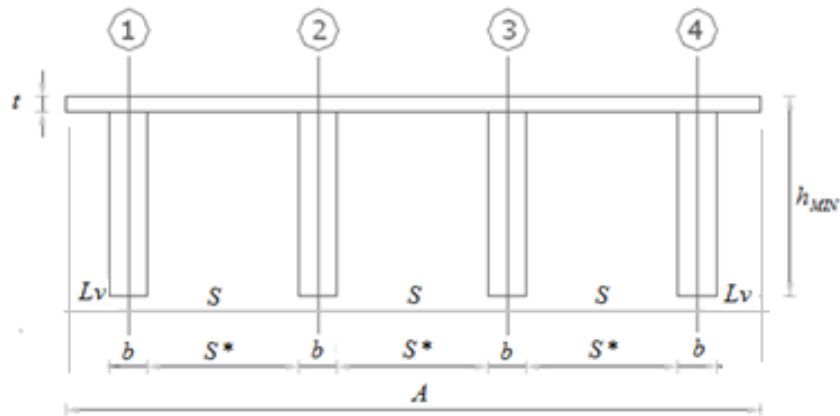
Nomenclatura en la sección transversal del puente en hormigón armado (alternativa “A”)
